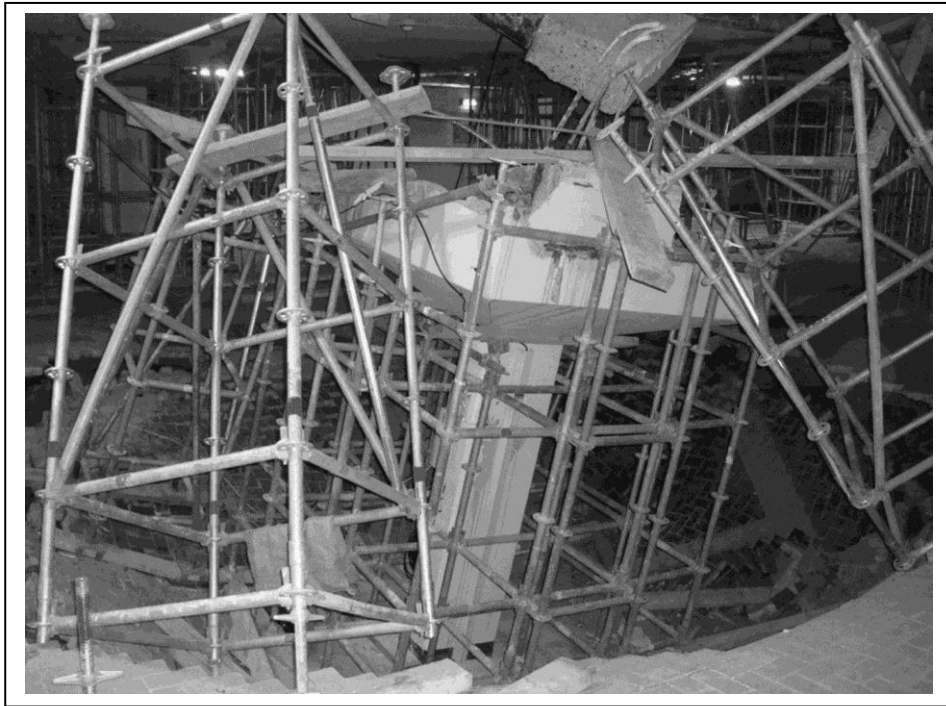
Tagesbruch mit zur Hälfte eingesunkener Betonstütze D 18 der Parkgarage
